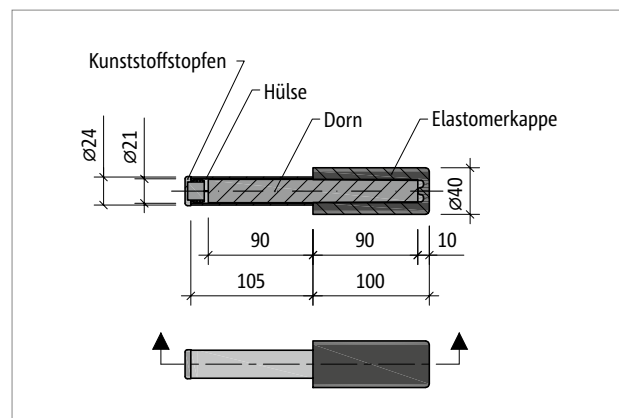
Schöck Tronsole® Typ D-H: Produktgrundriss
